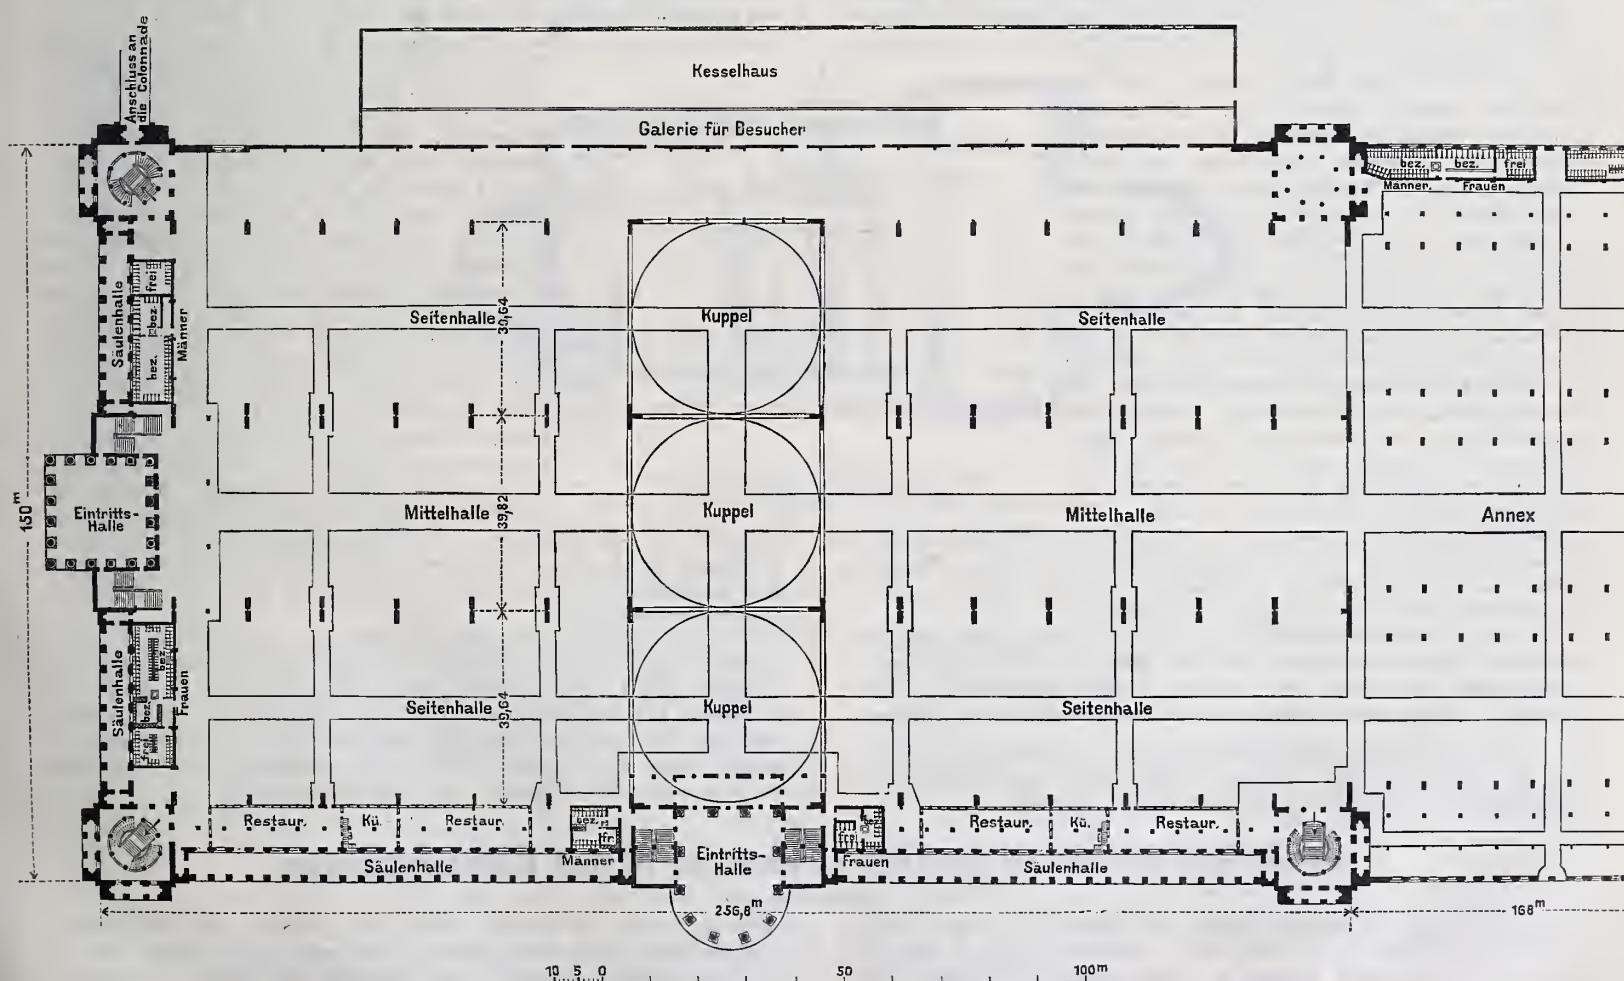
Grundriss der Maschinenhalle mit einem Theile des Anbaues.
